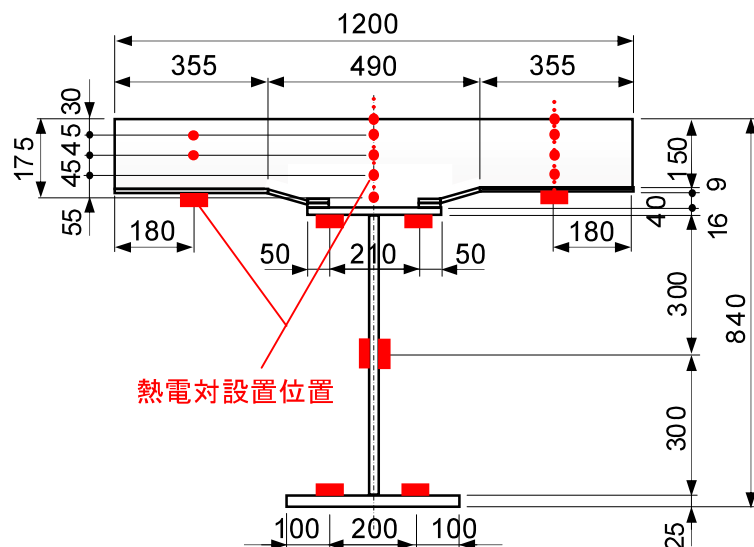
実験供試体の断面および熱電対設置位置（単位：mm）
